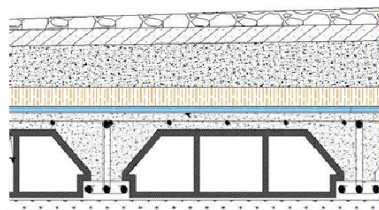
coupe verticale du dernier plancher (terrasse).
